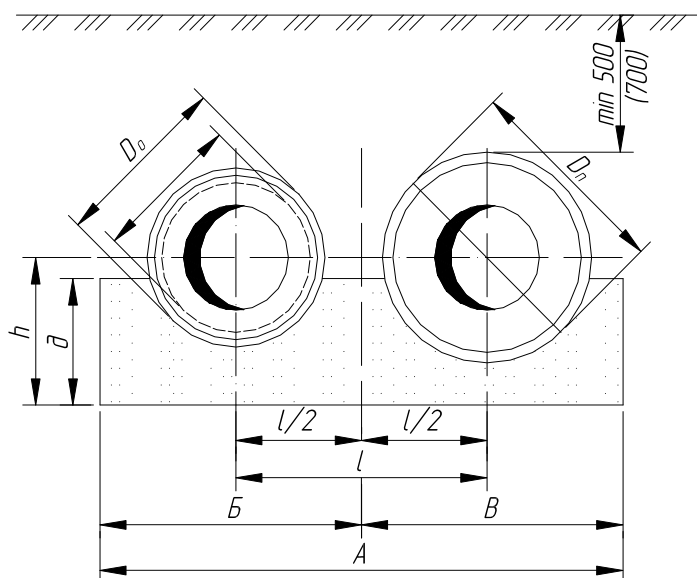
Приклад безканального прокладання тепломереж в армопінобетонній ізоляції в сухих ґрунтах (без дренажу)
